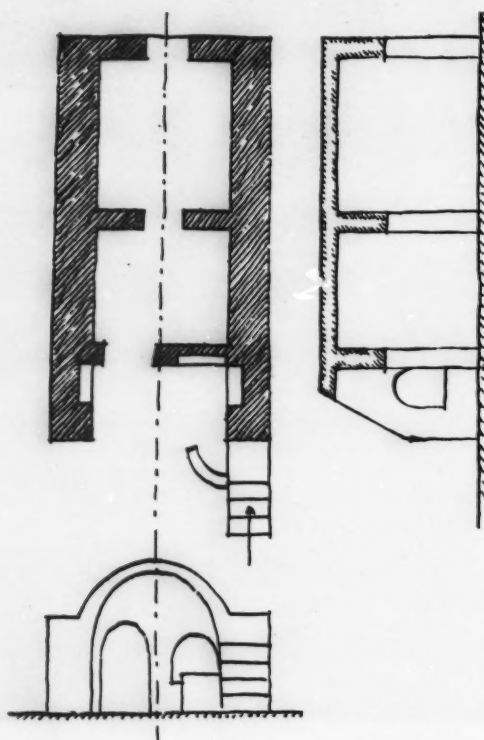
PLAN, ÉLÉVATION ET COUPE
